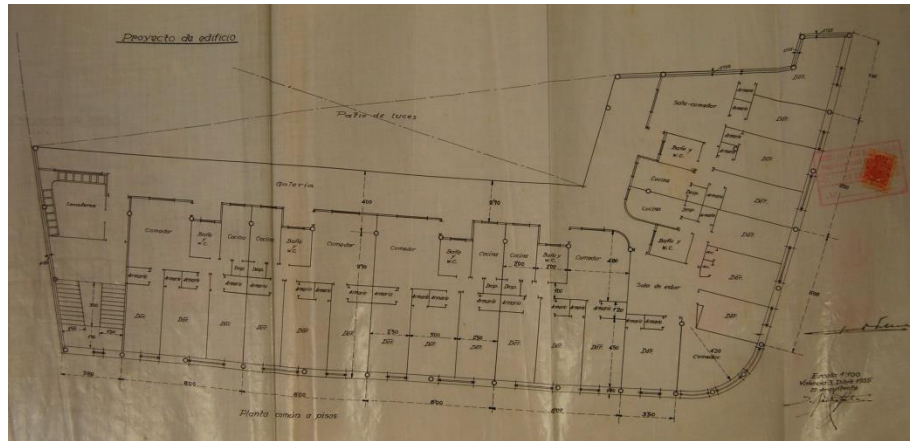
Planta común de las viviendas de los Almacenes Cuadrado
